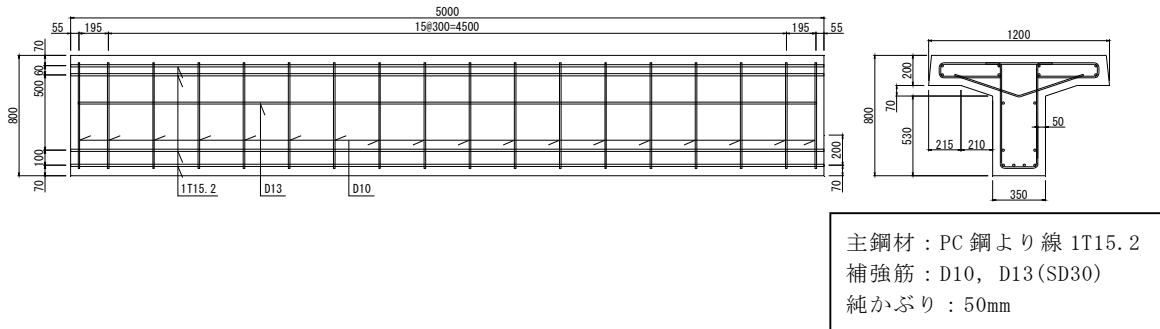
試験体形状（プレテンション方式大型試験体 S・T型）
